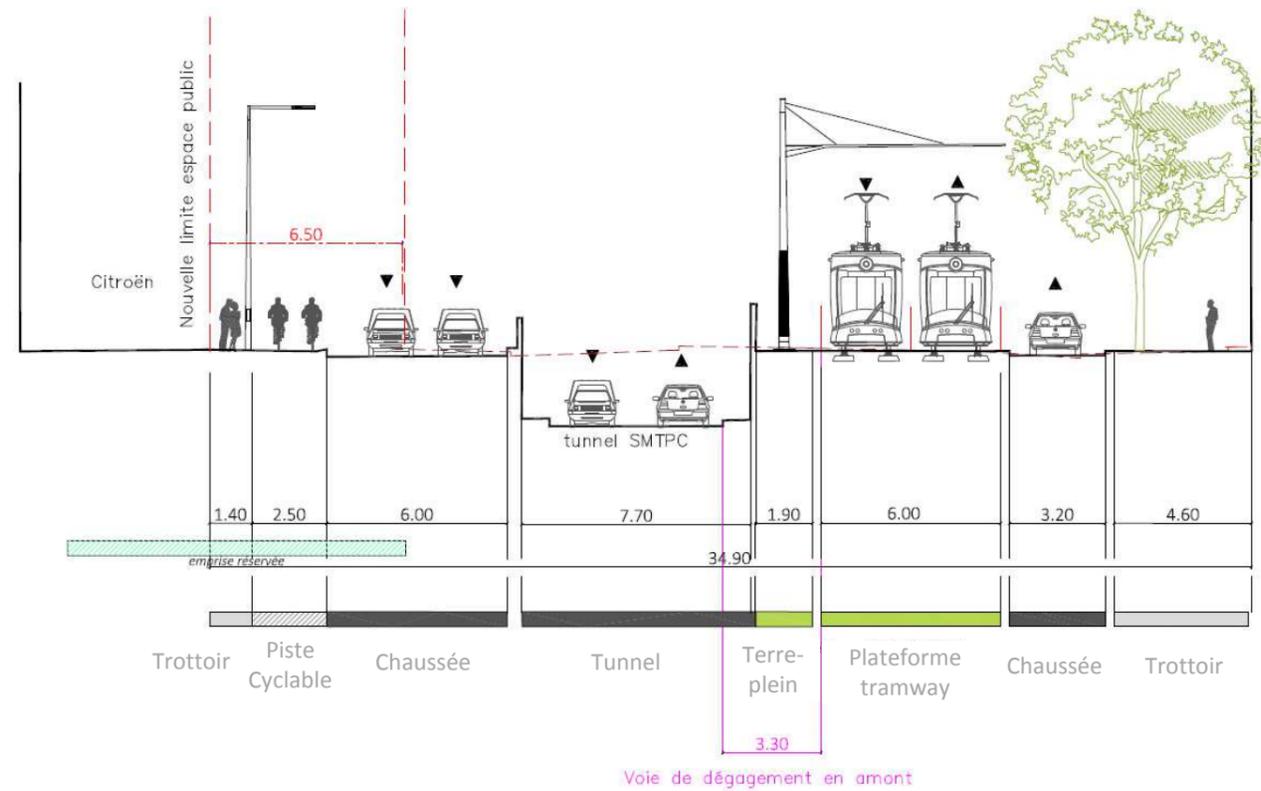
Profil du bd Schløesing au niveau de la trémie du tunnel
